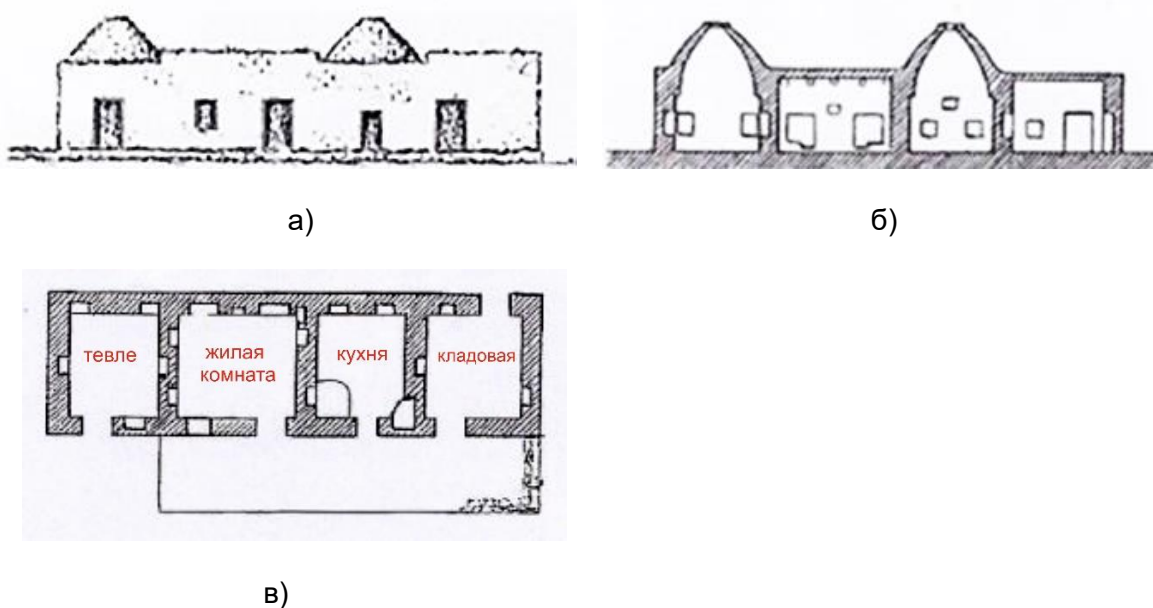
Жилой дом в селе Мардакян, конец XIX века: а) фасад; б) разрез; в) план
